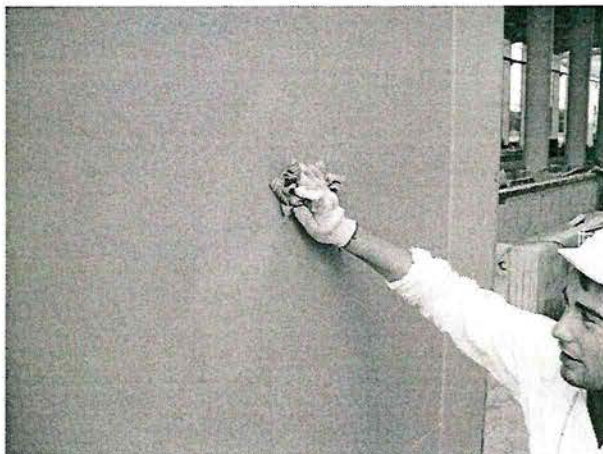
Очистка обрабатываемой поверхности щеткой
